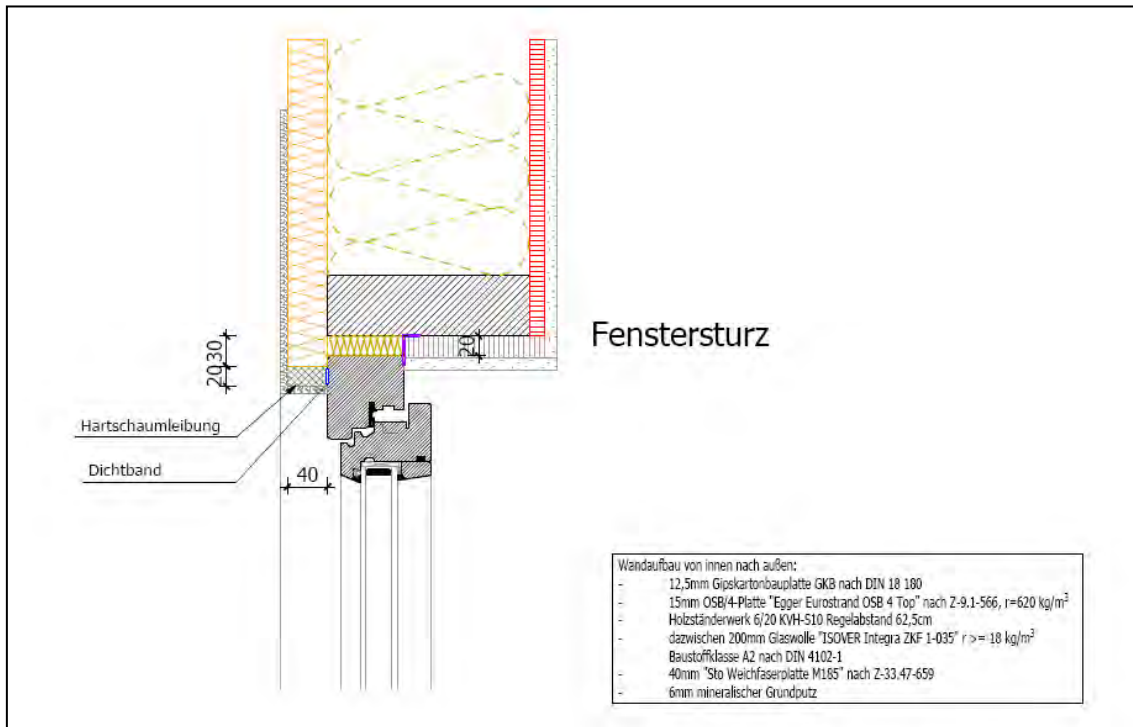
Bauteilaufbau Variante 2 (Wärmedämmverbundsystem WDVS)
